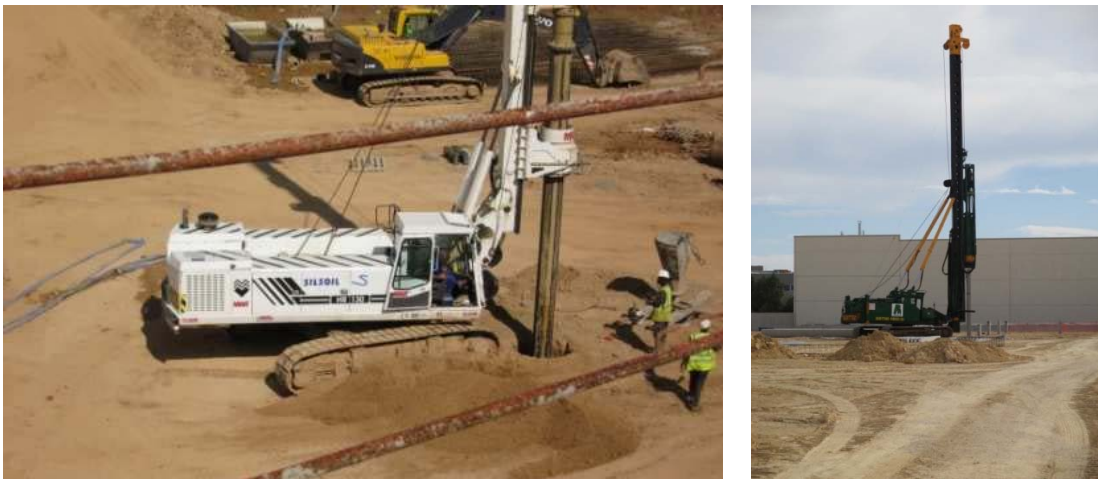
Proceso de Pilotaje in Situ y Prefabricado. Fuente: Silsoil y Elaboración Propia
